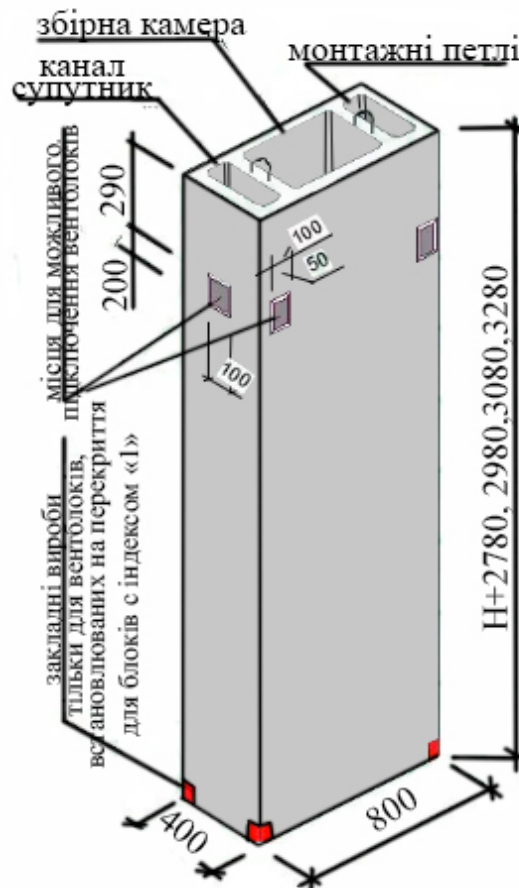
Конструкція залізобетонних вентиляційних блоків.
